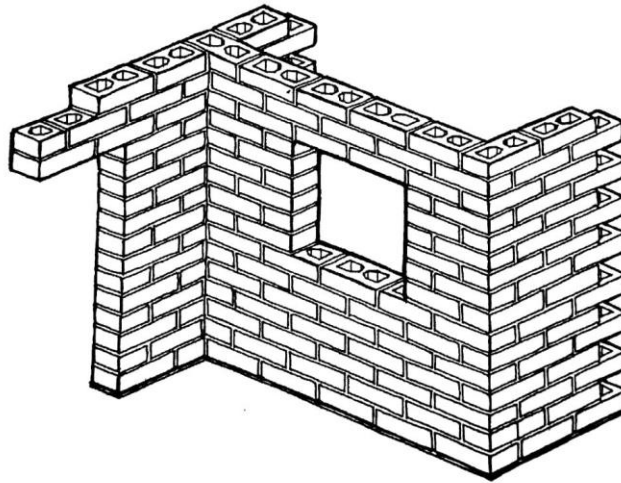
Esquema estructural de la mampostería no confinada. Adaptado de Maldonado Rondón y Chío Cho (2007). Visión estructural de las edificaciones de la ciudad de Bucaramanga.
